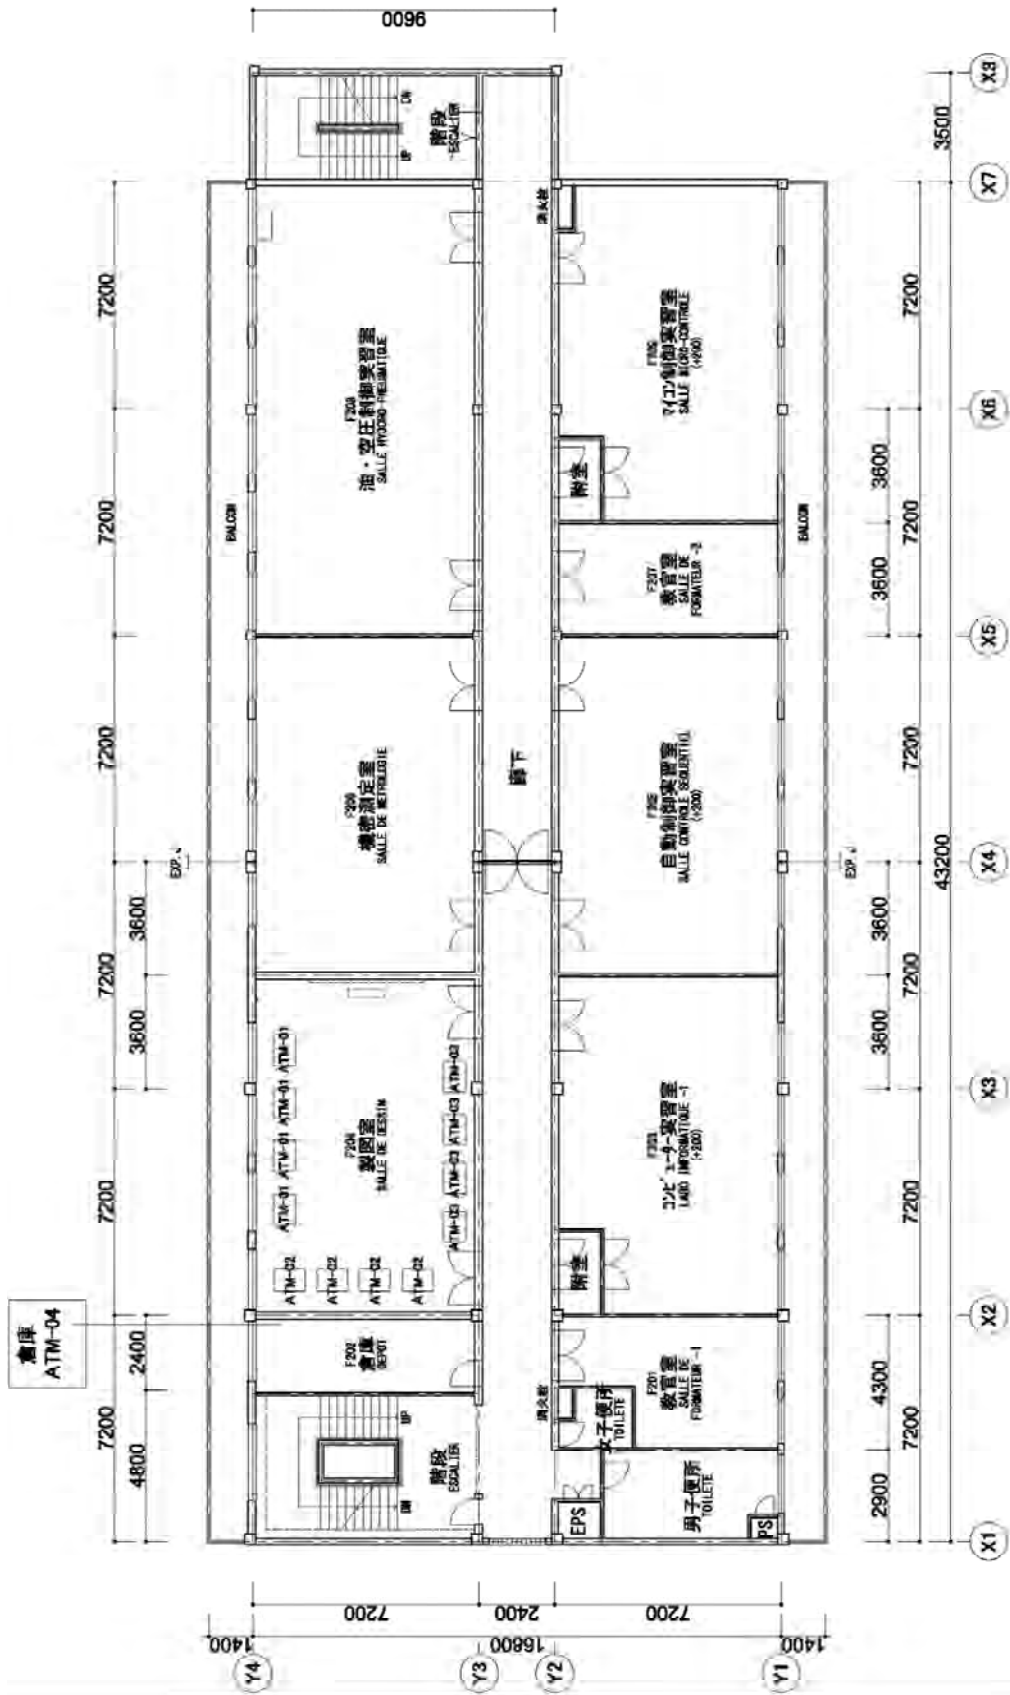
平面図・機材配置図 (F 棟 2 階 自動制御科)
